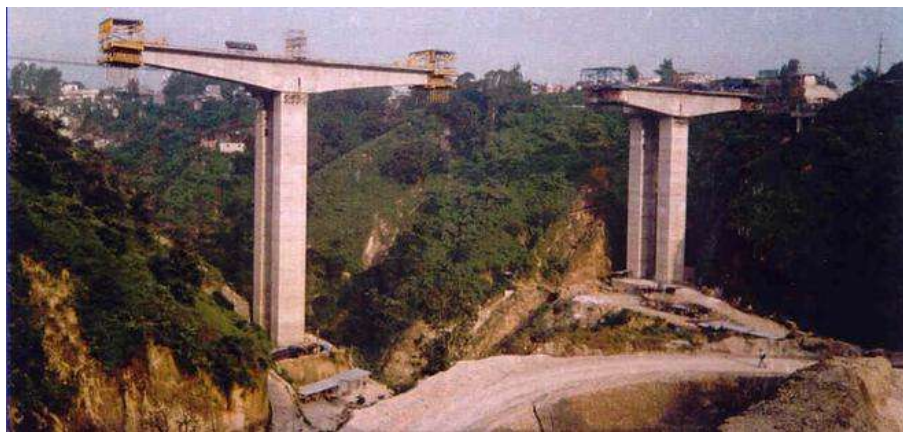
Ejemplo de construcción de un puente en voladizos sucesivos (Isunza, 2008).
